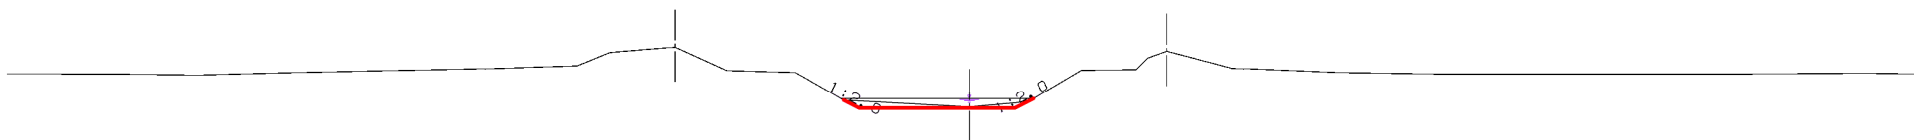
Section actuelle du chenal du tronçon entre ⑦ et ⑩
